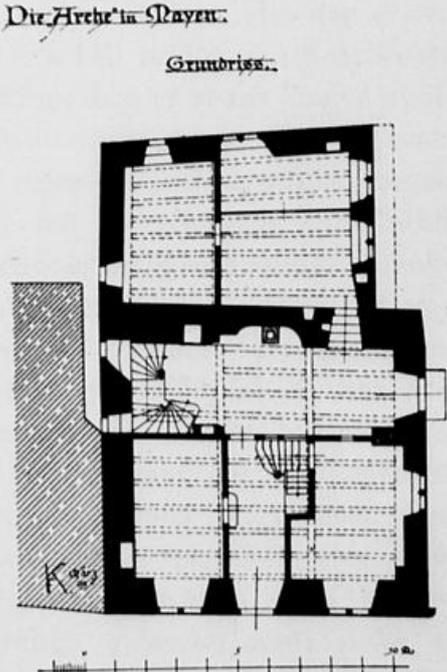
Mayen. Haus Arche. Erdgeschoss-Grundriss.
